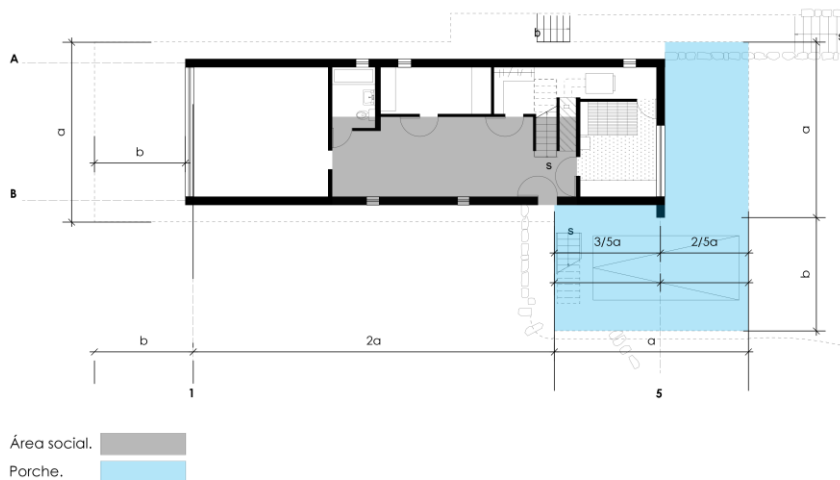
Proporciones del porche en planta baja edificación. Fuente: Autor.
